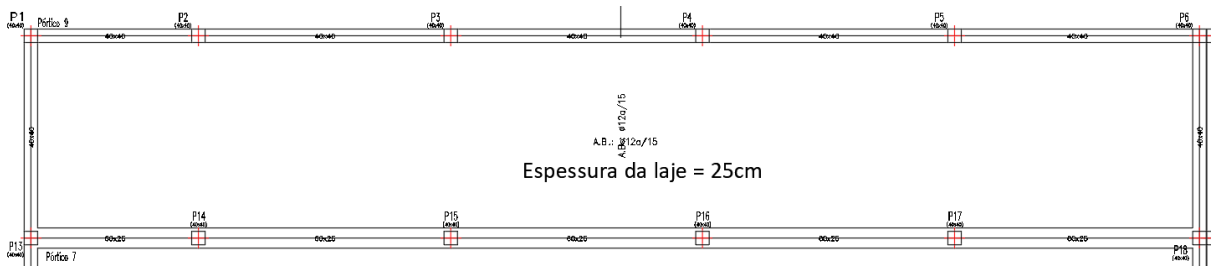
Pormenor do Pórticos 9 (Pilar P1 a P6) e Pórtico 7 (Pilar 13 a 18)
